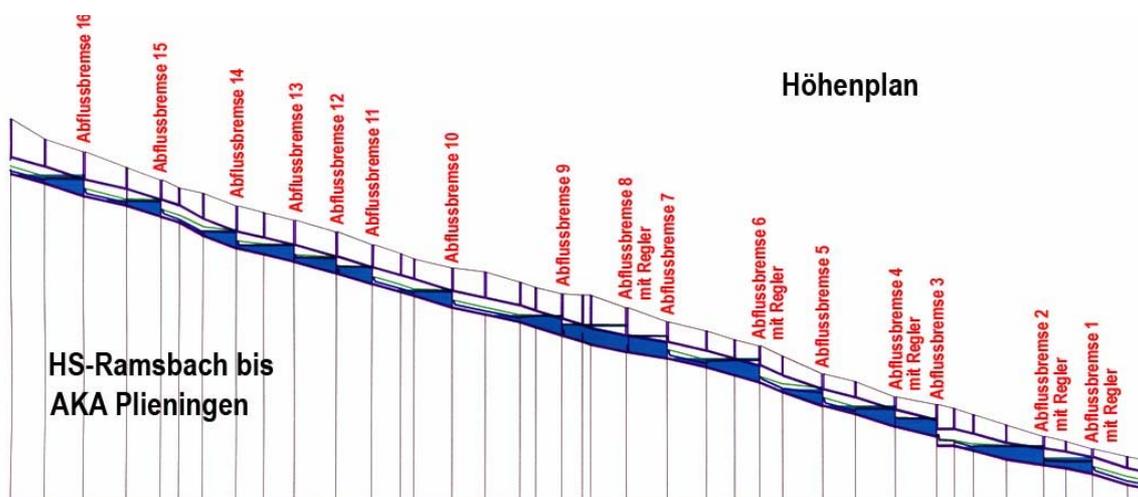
Höhenplan der Speicherkaskaden im Hauptsammler Ramsbach
